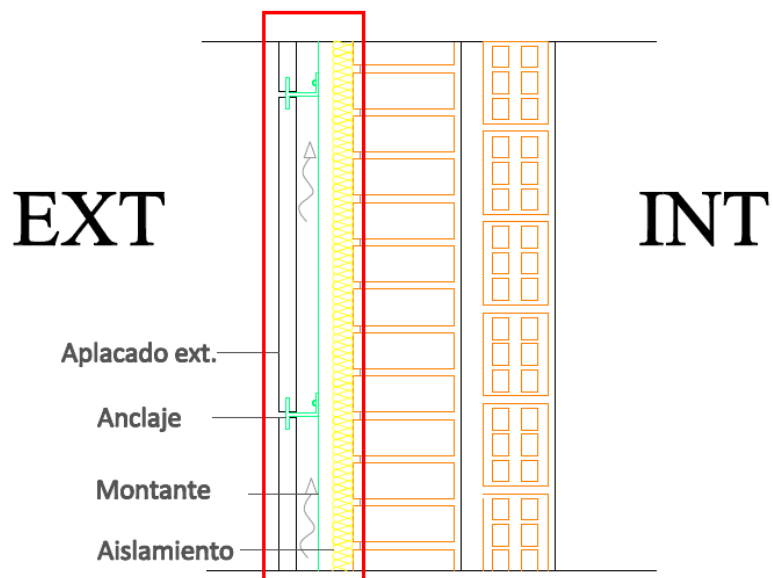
Reforma exterior con fachada ventilada en cerramiento de doble hoja
